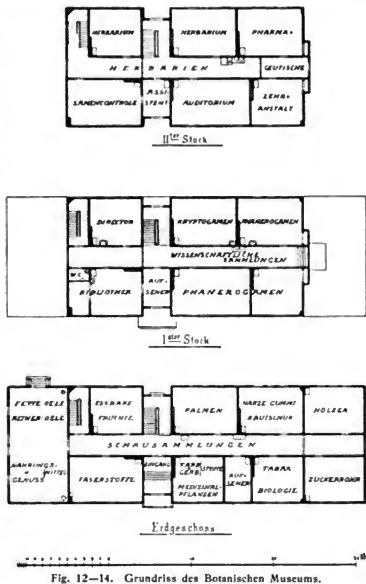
Grundriss des Botanischen Museums.
